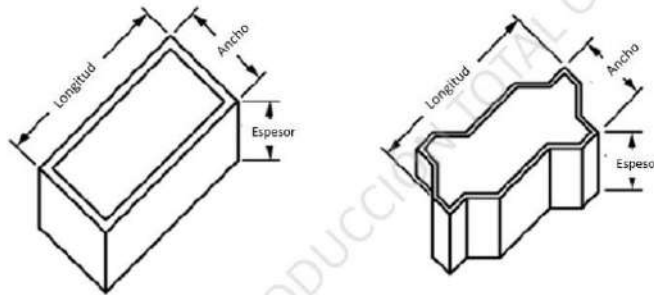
Longitud, ancho y espesor de las unidades de concreto para pavimentos
